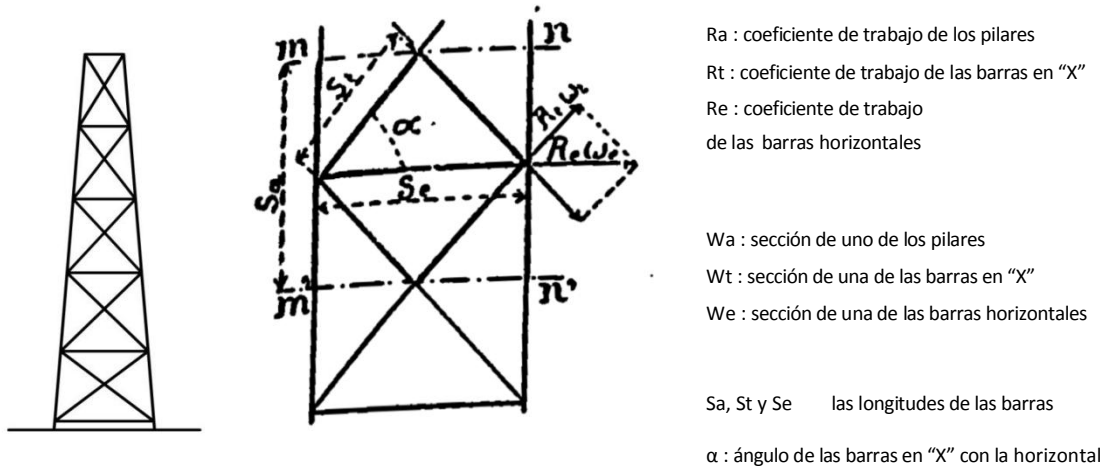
Pilastra de entramado del tipo de las utilizadas en el Puente de María Pía o en Viaducto de Garabit.
